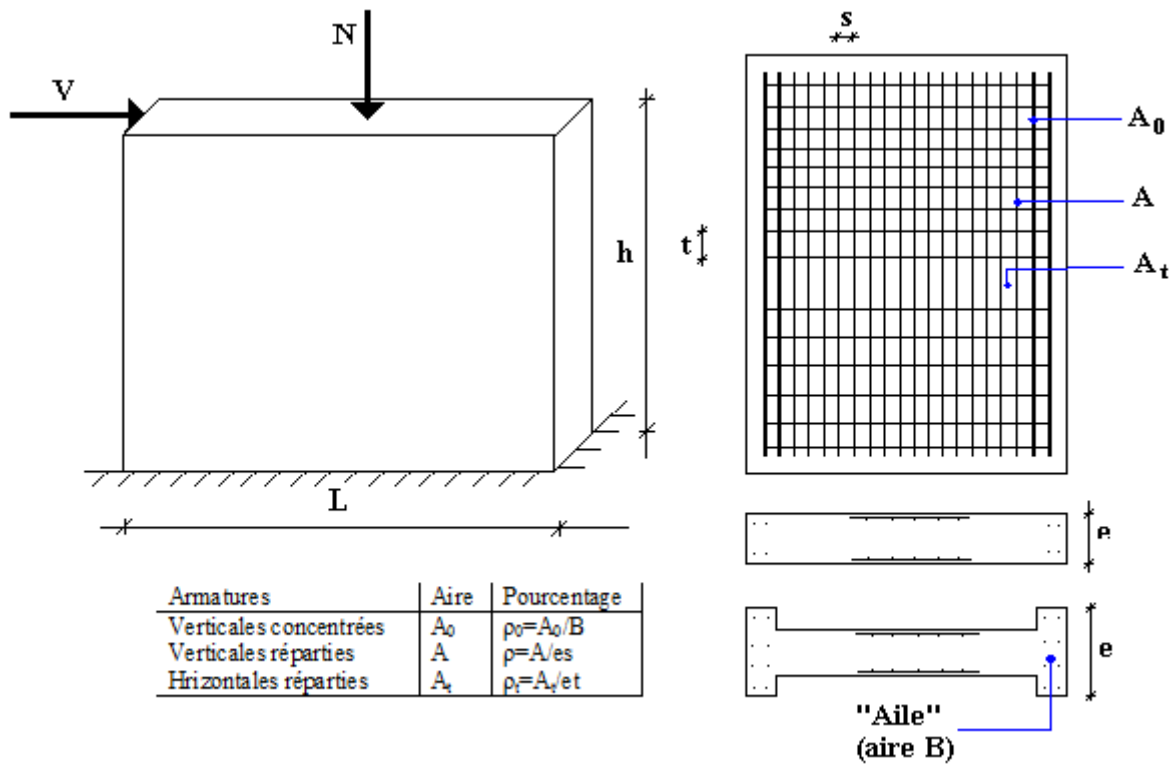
Schéma d'un voile plein et disposition du ferrailage
